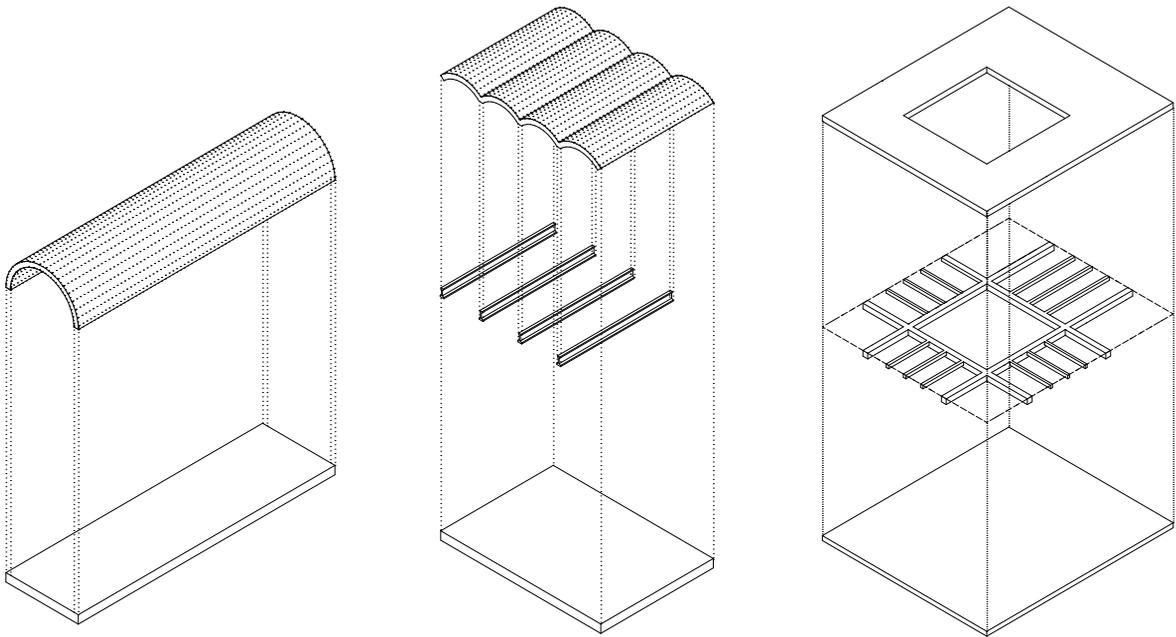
Deckenstrukturen - Tonnengewölbe, Kappendecke, Rippendecke
